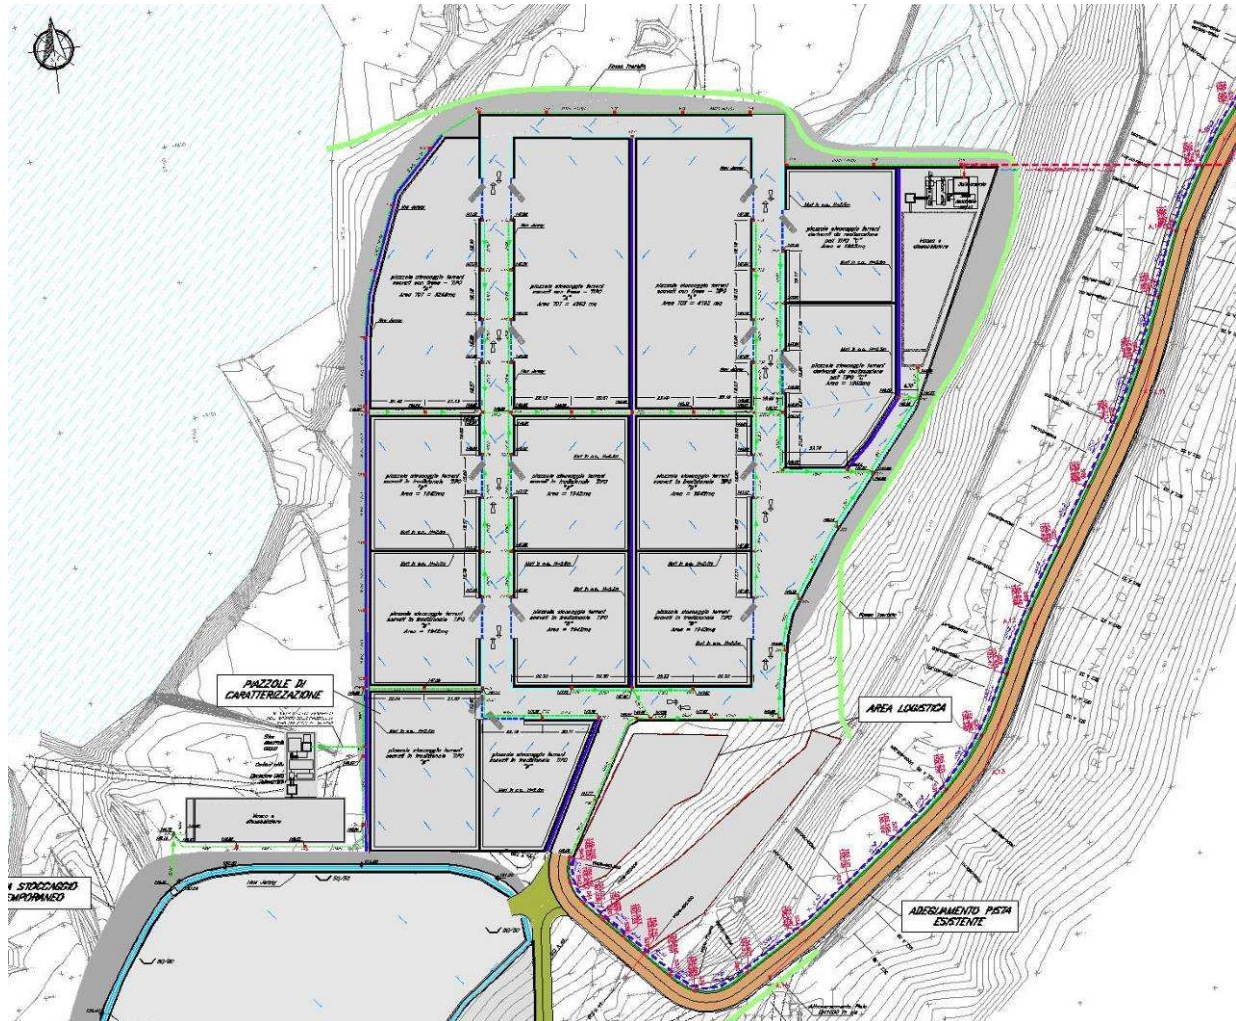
Planimetria idraulica Piazzole di caratterizzazione
